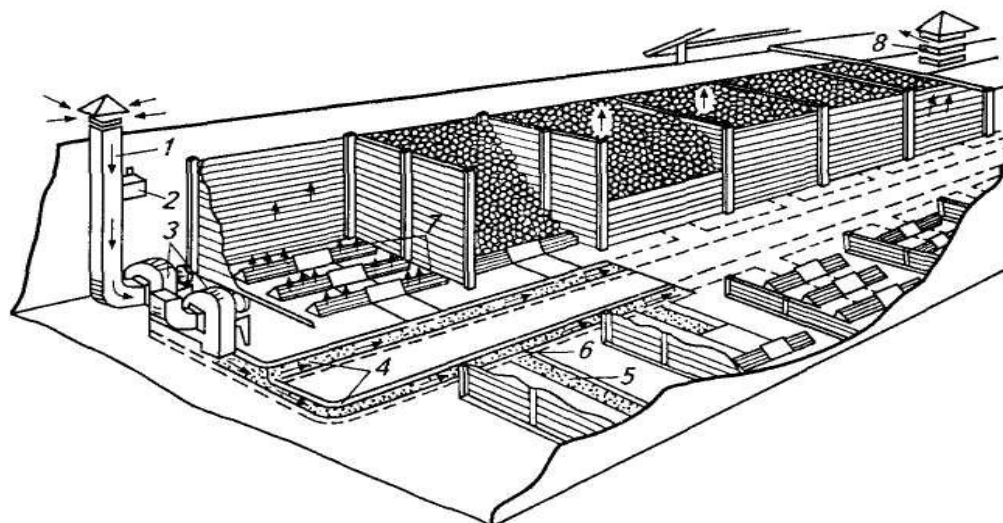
Схема закроного хранилища для корнеплодов:
